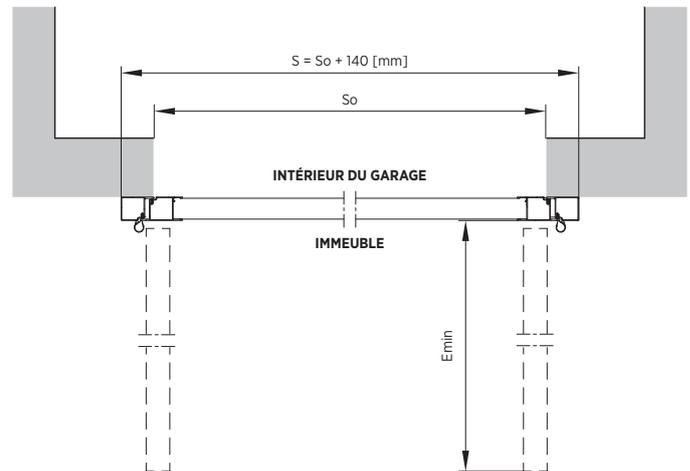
Pose devant la baie - coupe horizontale - Porte battante à deux vantaux Presto 50
